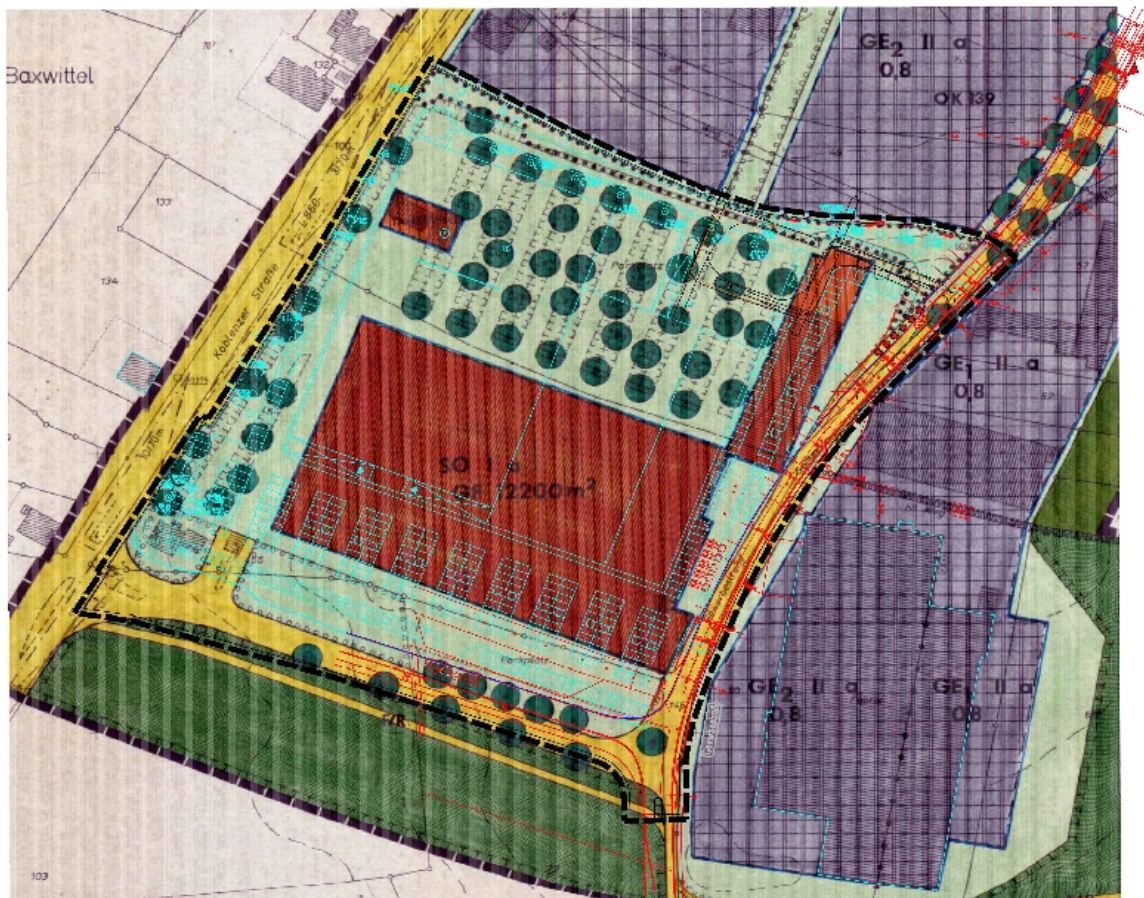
Verschneidungsplan Alt-Bebauungsplan und 5. Änderung
